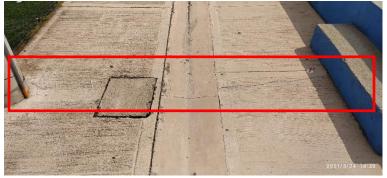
Fisuras en andén perimetral de la cancha – OCI 24-03-2021
